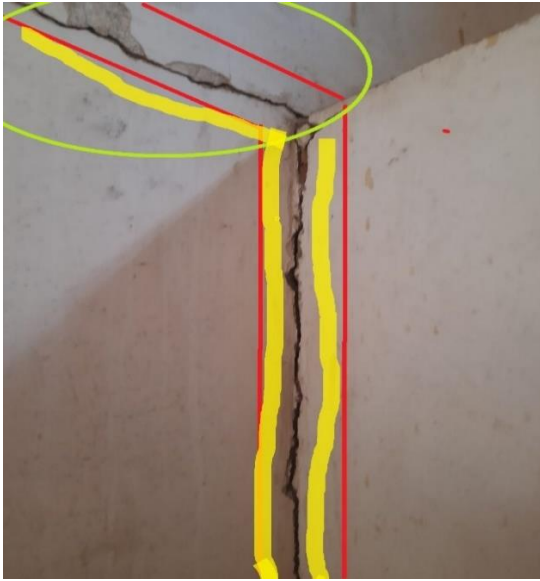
Caso severo de inestabilidad en la infraestructura, área con mayor afectación en la casa.
